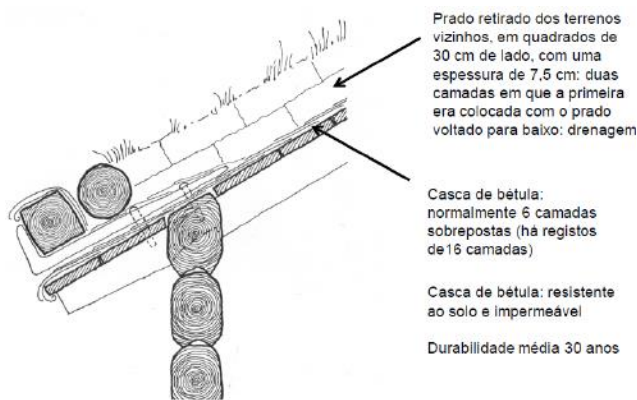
Esquema do perfil de um telhado de trufa fonte slides Paulo Palha
